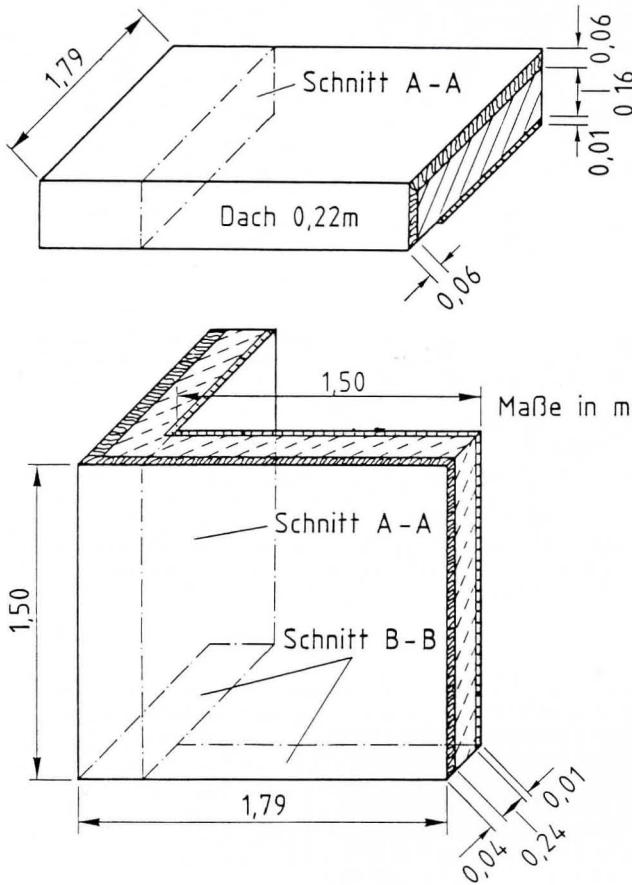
Ecke aus zwei Außenwänden und einem Flachdach, dargestellt für den Fall des optimalen Wärmeschutzes (Konstruktion 7)
